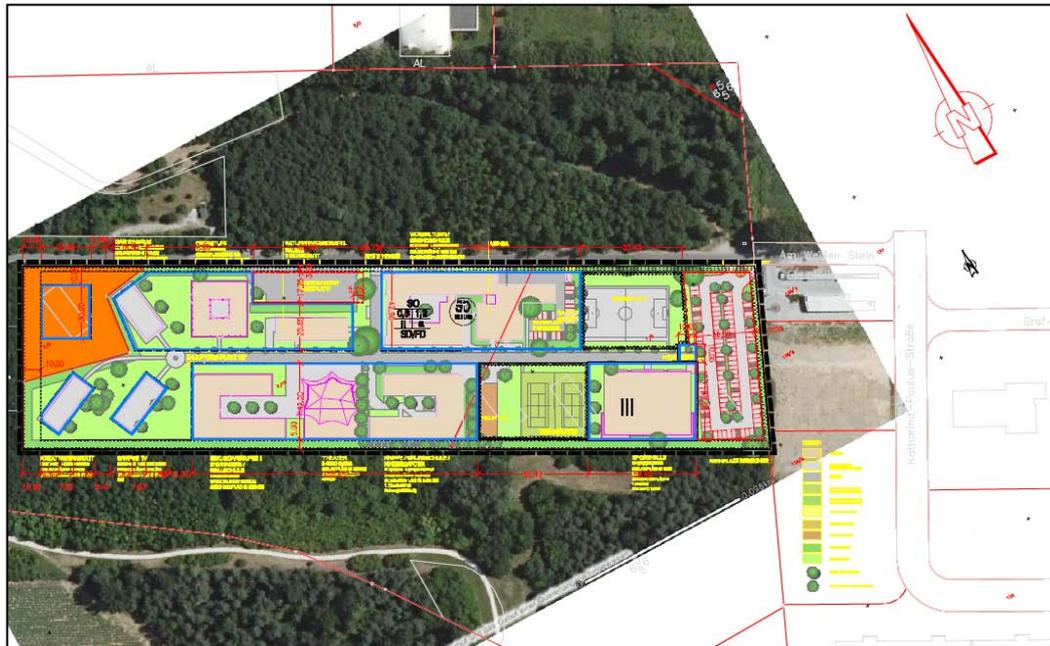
Geplanter Parkplatz am östlichen Rand der Bebauung
